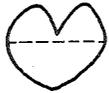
Querschnitt durch Brückenkörper für Schwebebrücke
